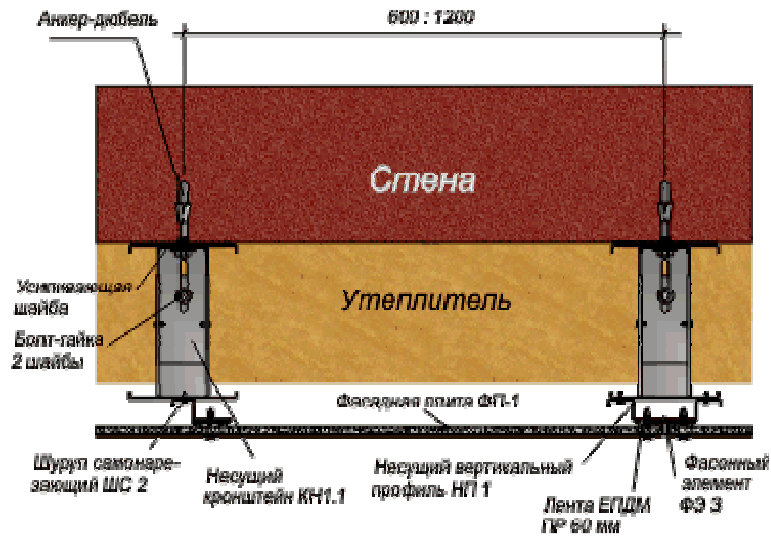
Крепления фасадной плиты к несущему профилю
